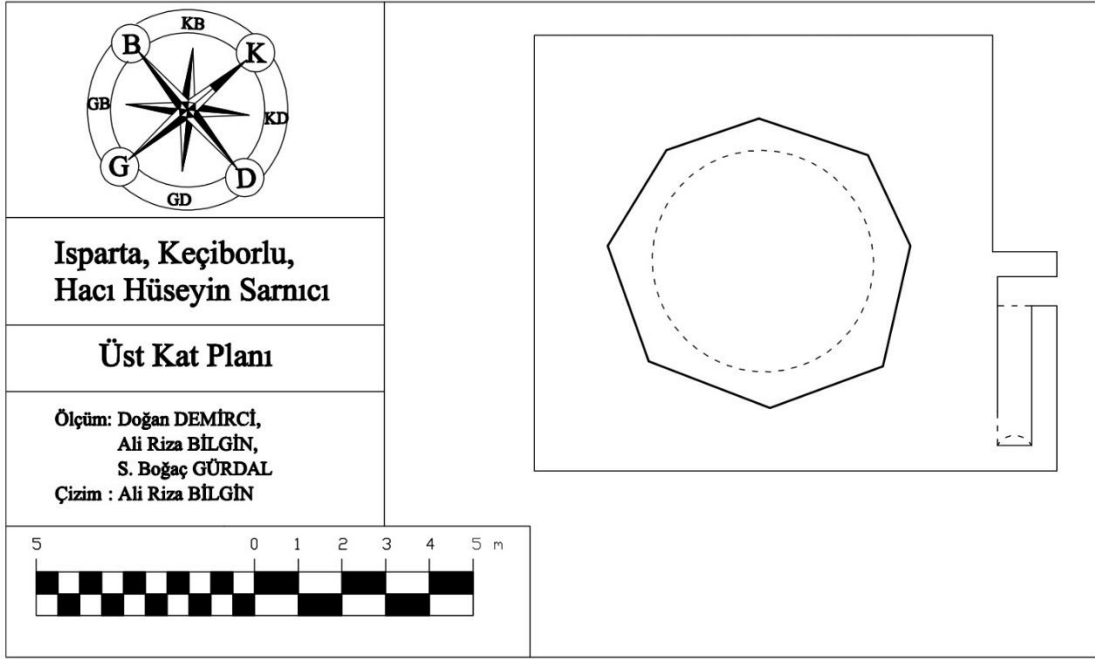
Hacı Hüseyin Sarmıcı, Üst Kat Plan.
